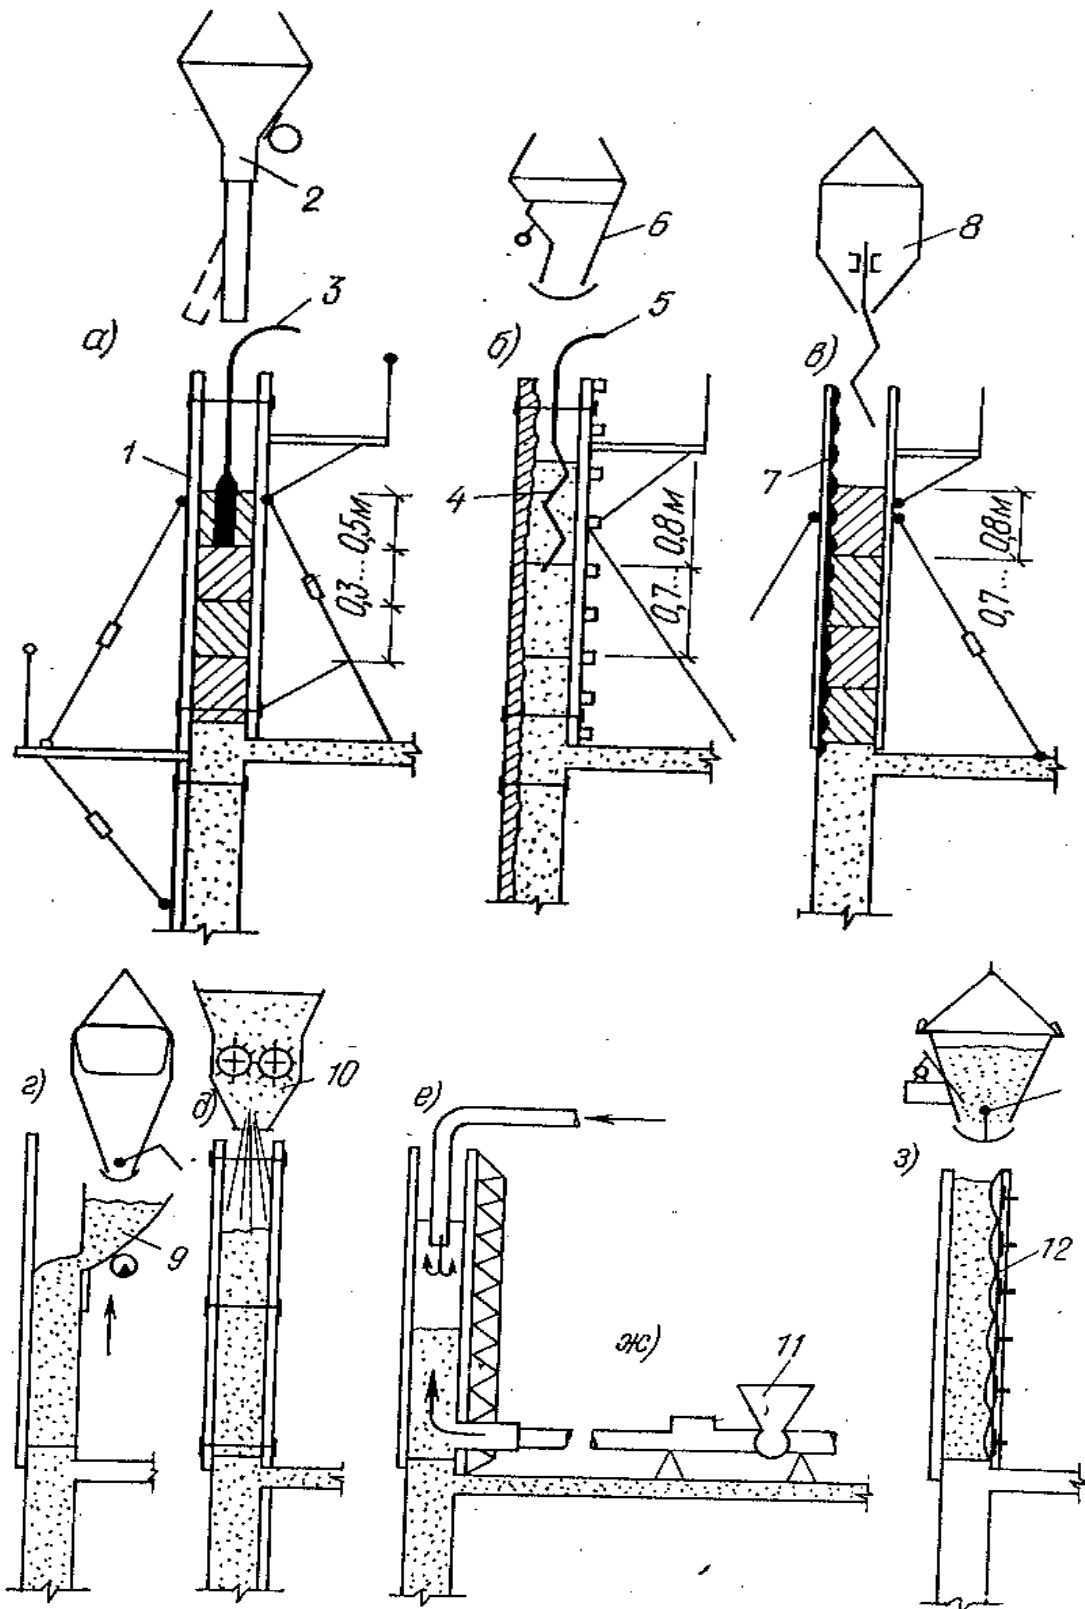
Технологічні схеми бетонування стін:
